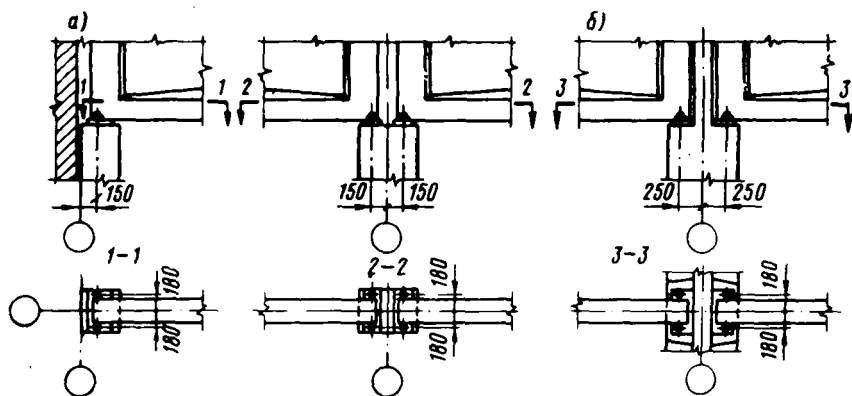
Привязка стропильных балок для зданий с плоской кровлей
